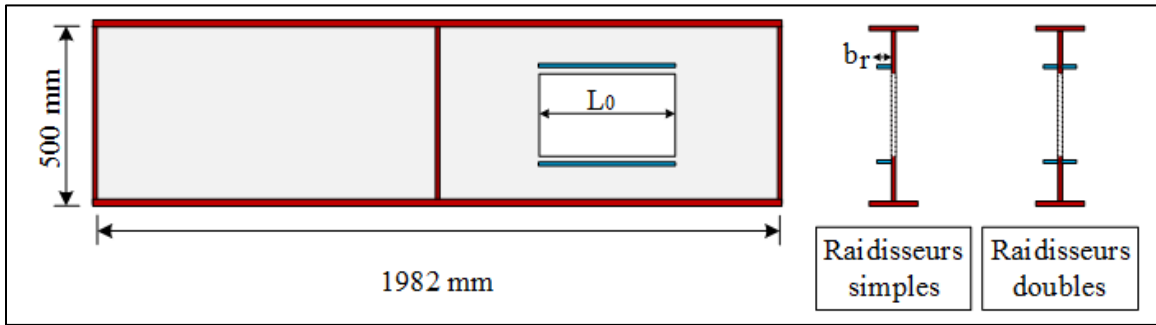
Paramètres des raidisseurs horizontaux sans ancrage
